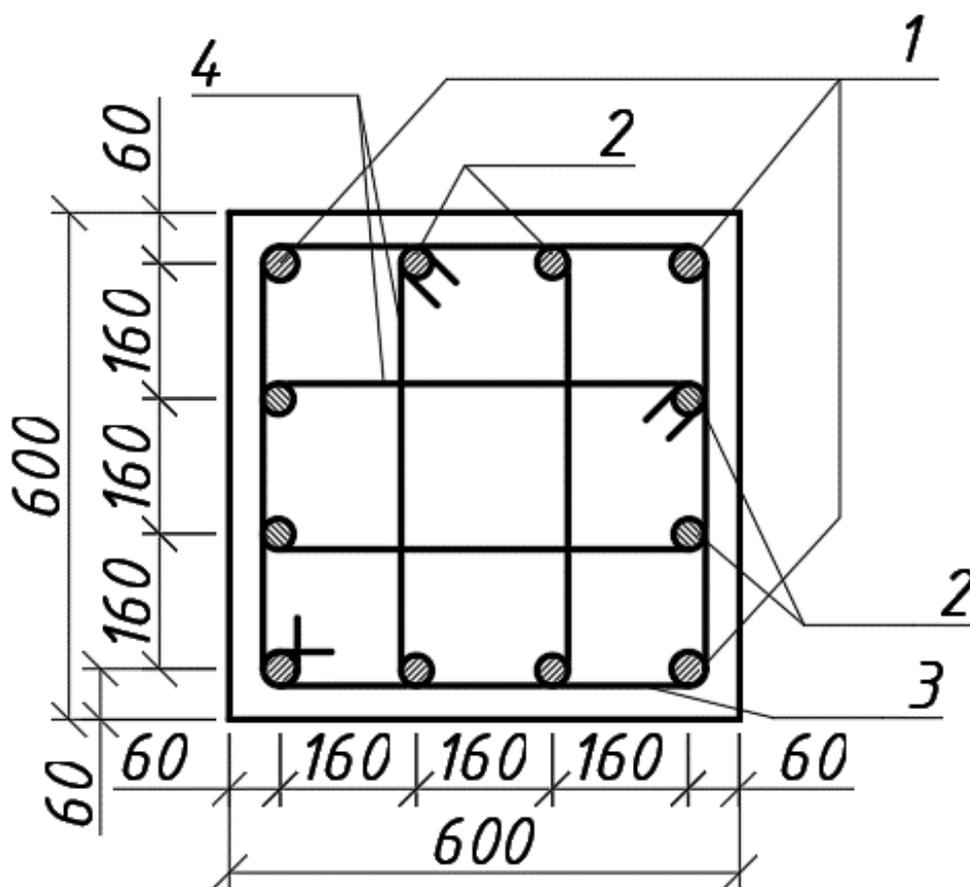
Армирование самой нагруженной колонны во втором варианте конструирования
